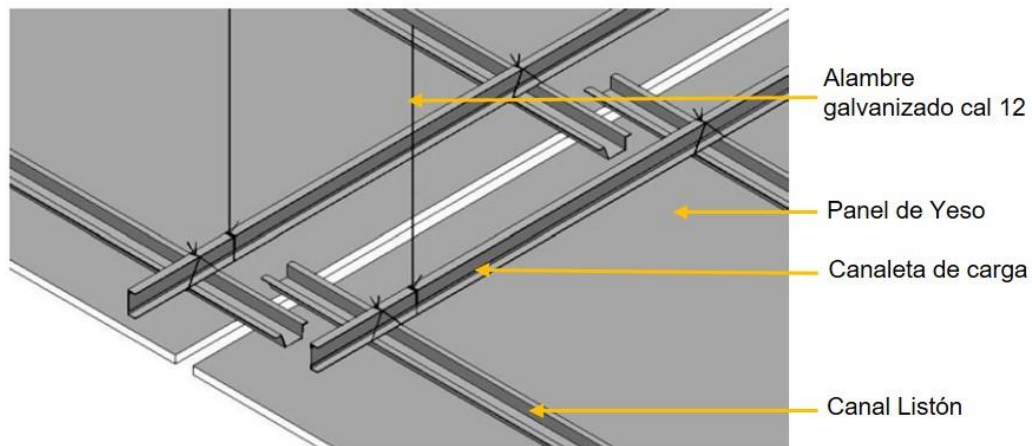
Instalación y armado de canales de carga y listón en plafón de panel de yeso (USG CORPORATION, 2000 5ta Edicion).
